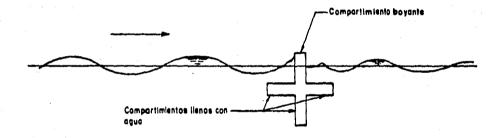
ROMPEOLAS TIPO BOMBARDON.
